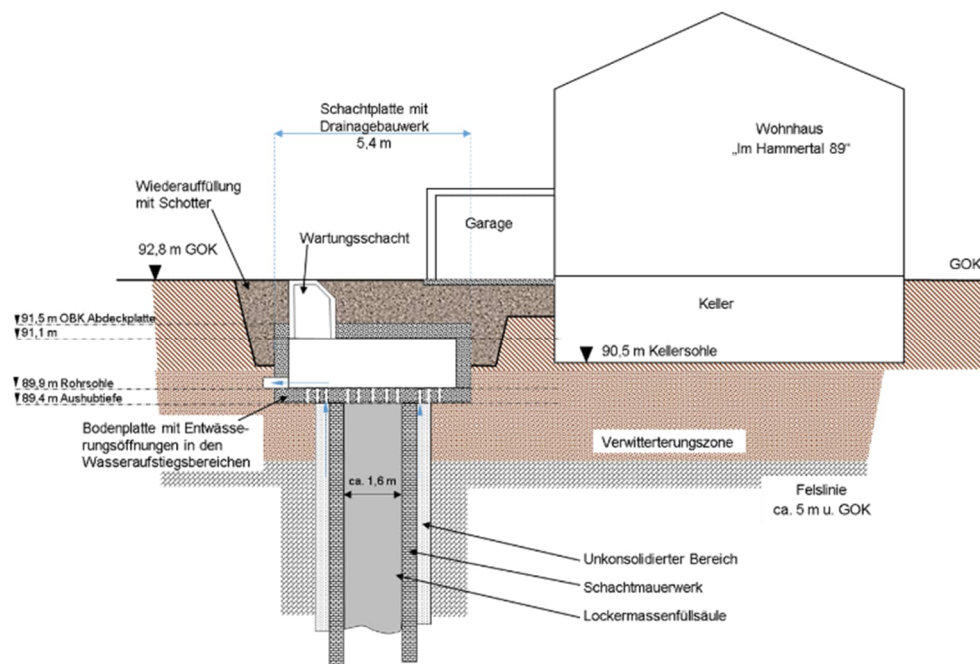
Schnitt durch das geplante Sicherungs- und Drainagebauwerk
